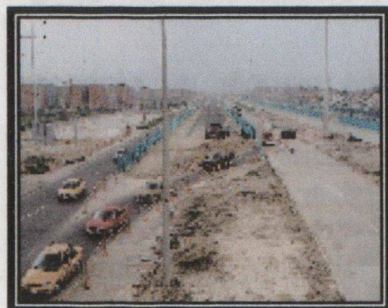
Separador en construcción tramo 1. 30-03-03
